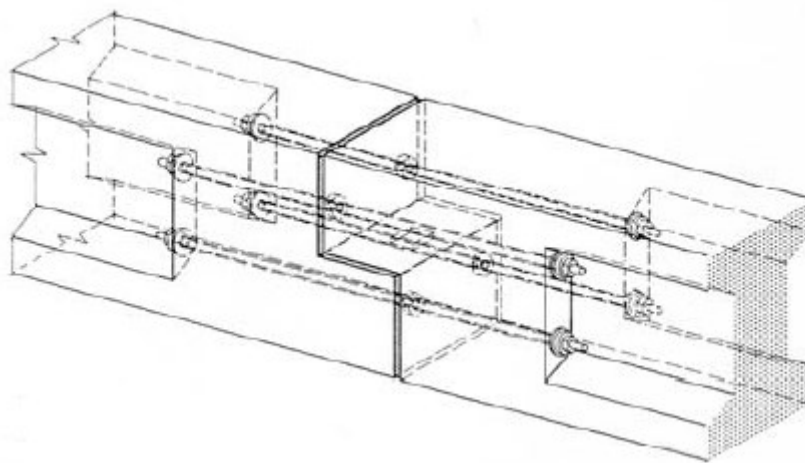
Modelo de ligação viga – viga recorrendo a juntas dentadas e barras (STUPRÉ, 1981).
